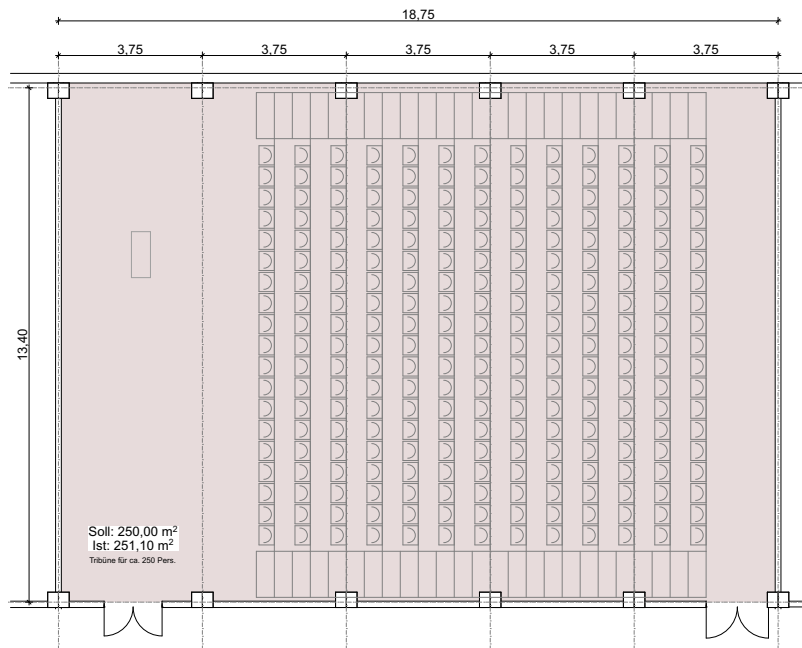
Grundriss kleiner Hörsaal, großer Seminarraum, Foyer 250 m²
